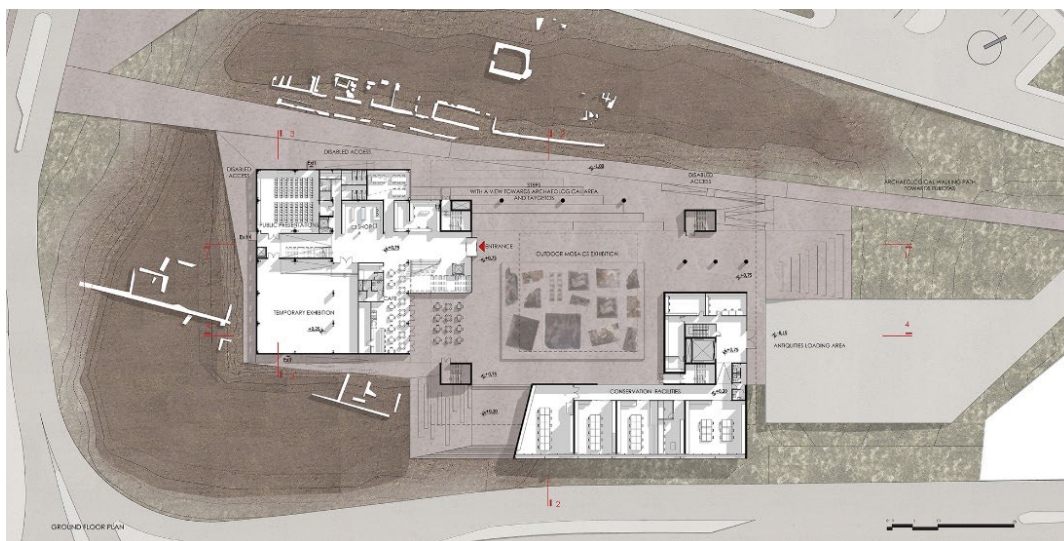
Le plan de rez de chaussée de musée de sparte. (archdaiy.com)
